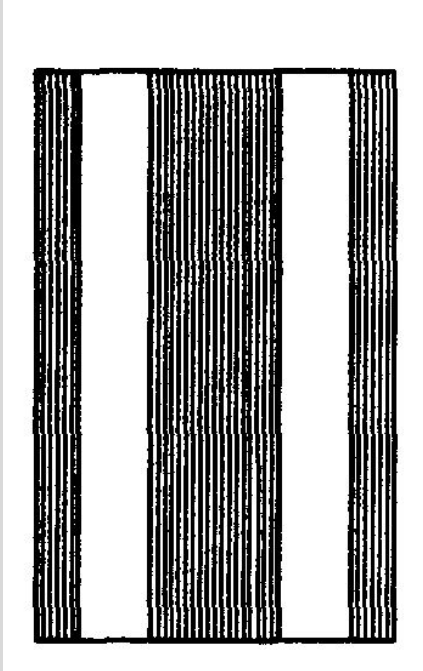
Системы зданий с железобетонными связевыми элементами:
